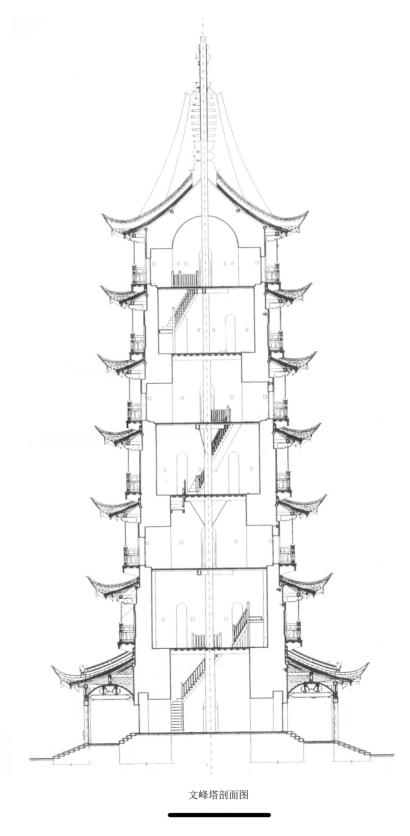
Cutaway drawing of the Wenfeng Pagoda 图 3. 文峰塔剖面图
